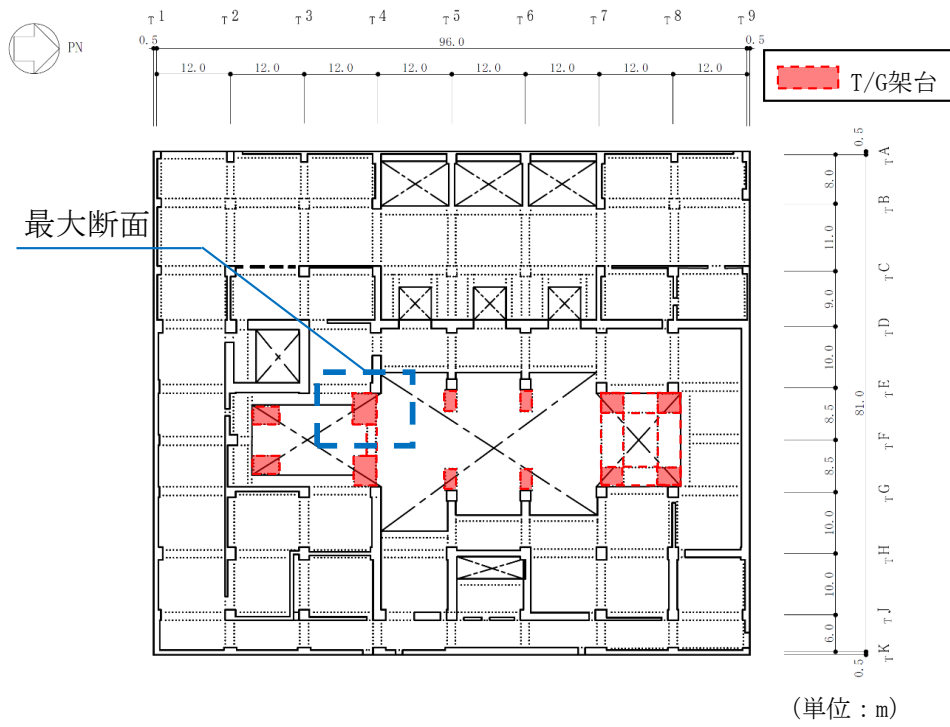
モデル化部の平面図 (1F, T.M.S.L. 12.3m)
